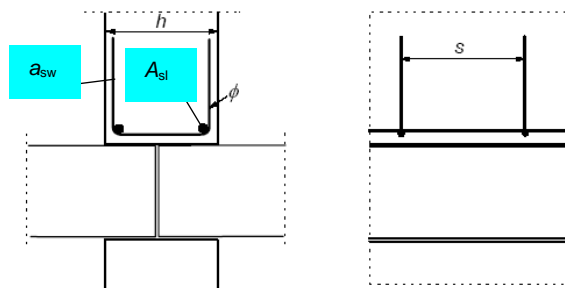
Beispiel zur Bewehrung einer Wand über der Verbindung zweier Deckenplatten.
